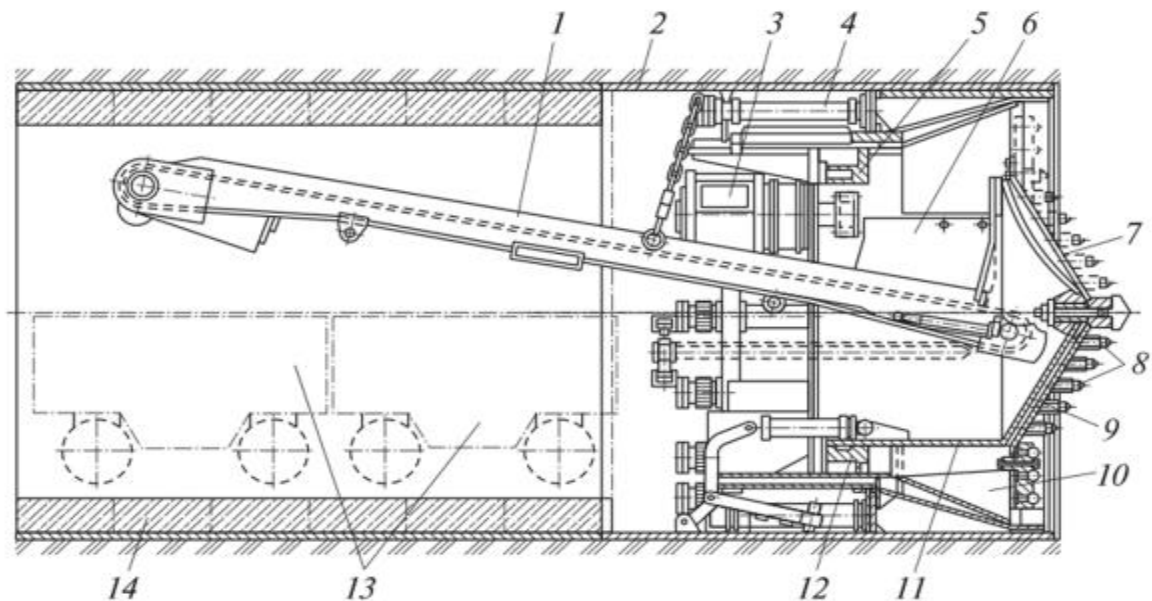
Механізований прохідницькі щит діаметром 2,56 м з роторним робочим органом, що складається з роторної частини і неповоротного циліндра 1 - стрічковий конвеєр-перевантажувач; 2 - корпус щита; 3 - електродвигун; 4 - гідравлічні домкрати; 5 - зубчастий вінець; 6 - приймальне вікно; 7 - передній конус; 8 - змінні різці; 9 - неповоротний циліндр; 10 - спіральні лопатки; 11 - неповоротний циліндр; 12 - напрямні вздовж осі щита; 13 – візки; 14 - кільце обробки.
